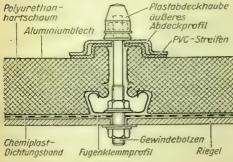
Dachdeckung (ähnlich Außenwand) Stützkernelement Al-Pur-Al, unten Fugendichtung
